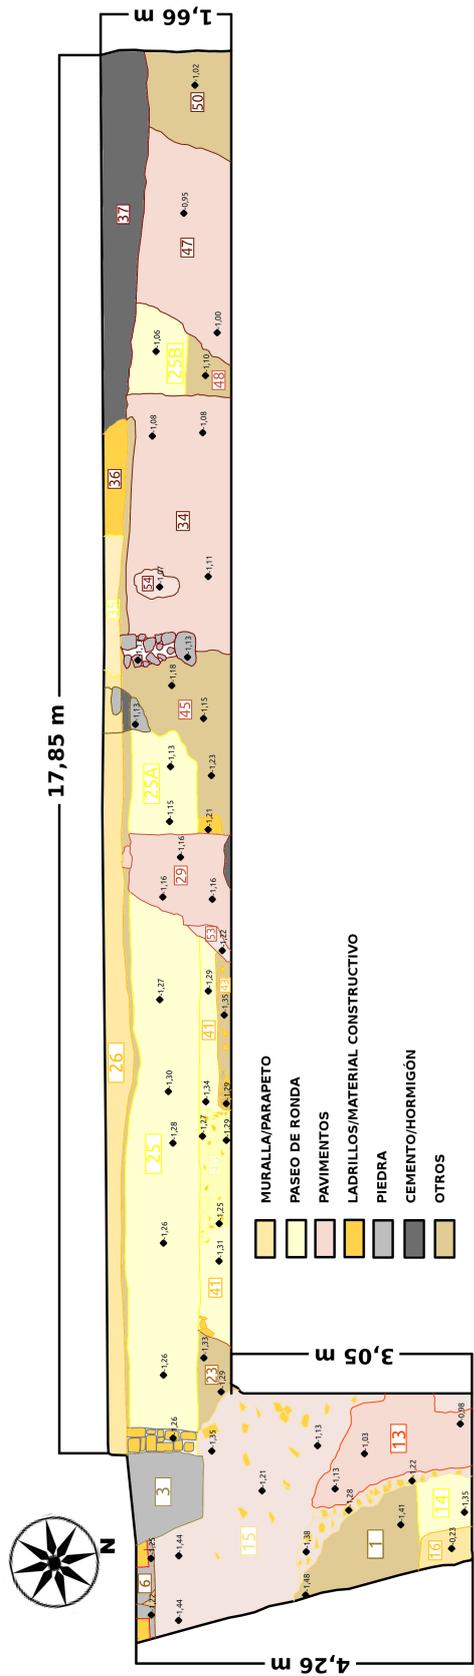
Planimetría general de las estructuras principales halladas en la Plaza de Armas del Castillo de Santaella
